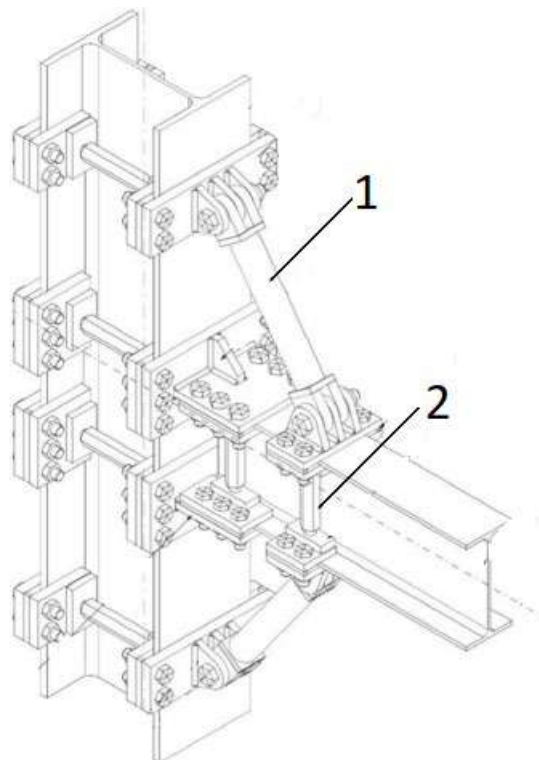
Unión a 90° de extremo de viga a pilar para absorción de efectos sísmicos (fuente: Fig. 1 de Pongiglione et al. 2021).
